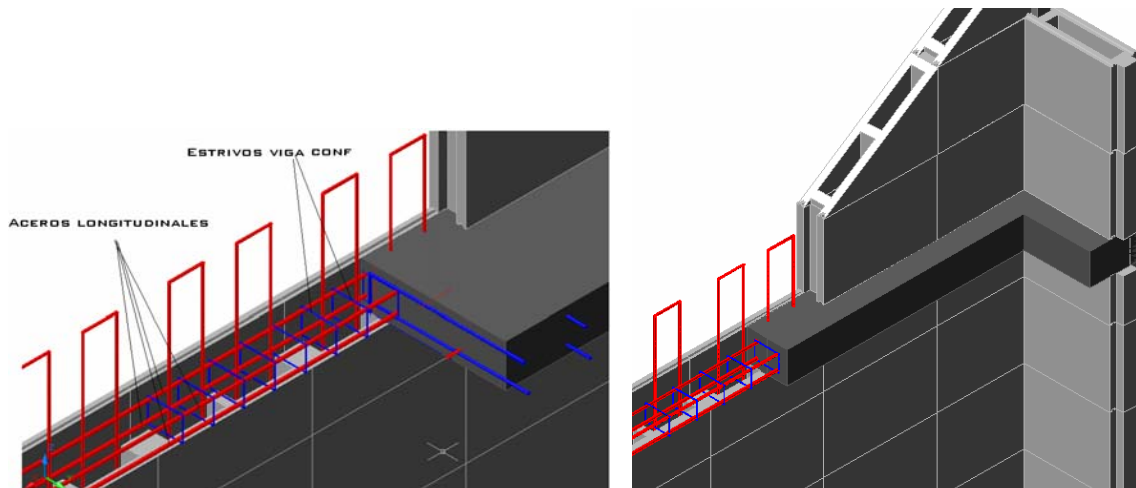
VIGAS DE ENTREPISO Y TECHO GRUPO B ZAS.
